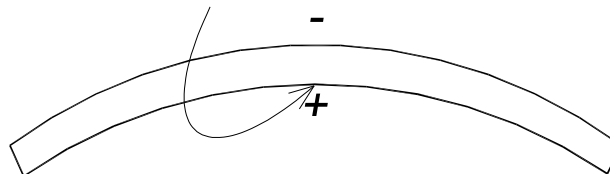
Losa de Cimentación en la condición Center Lift.
